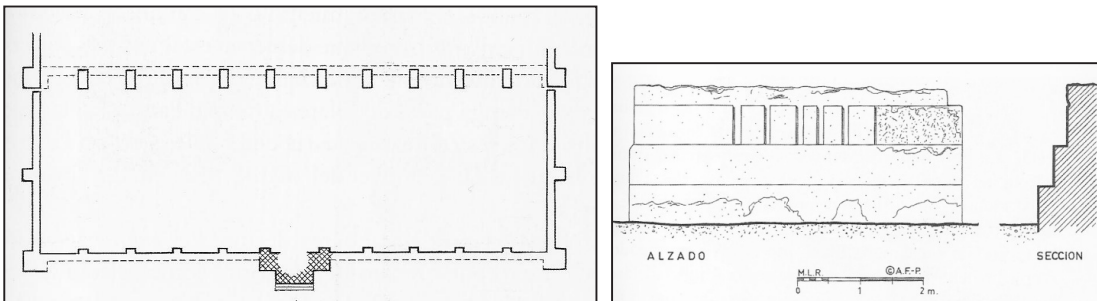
y 6. Planta y alzado según M. López Reche y A. Fernández-Puertas.
